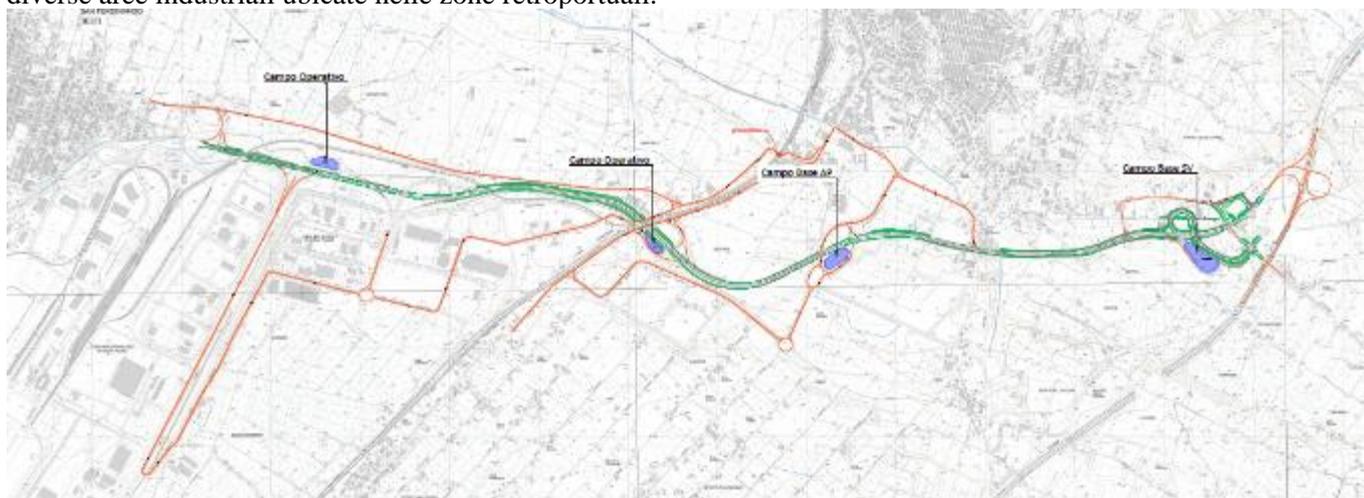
Planimetria di localizzazione dei cantieri e viabilità
